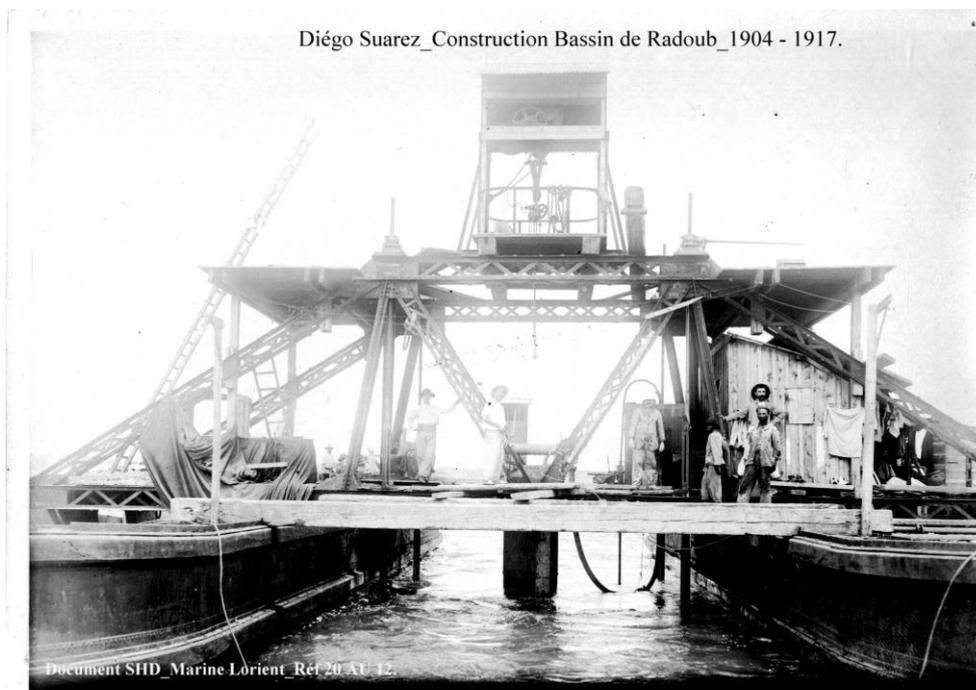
La cloche à plongeur et son installation de mise en œuvre (Archives SHD Lorient)
